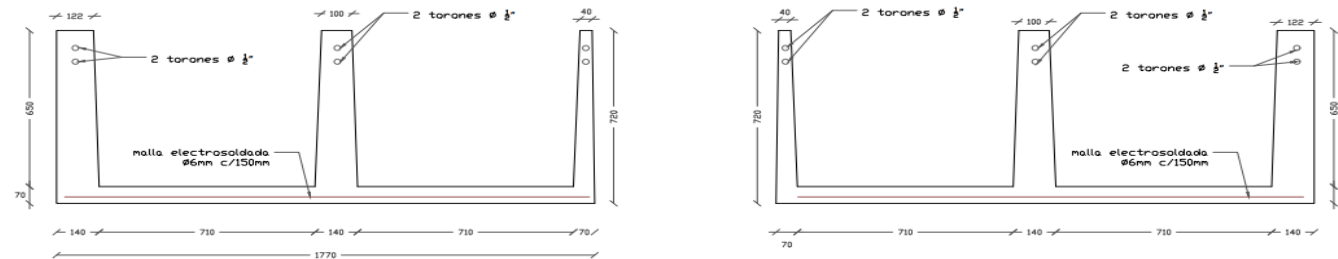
Plano de la vista en planta y elevación del módulo de bloque de bóveda
